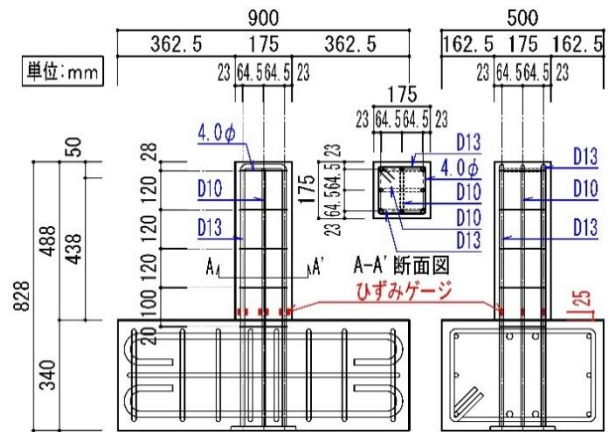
基準試験体の形状、寸法及び配筋詳細⁴⁾
